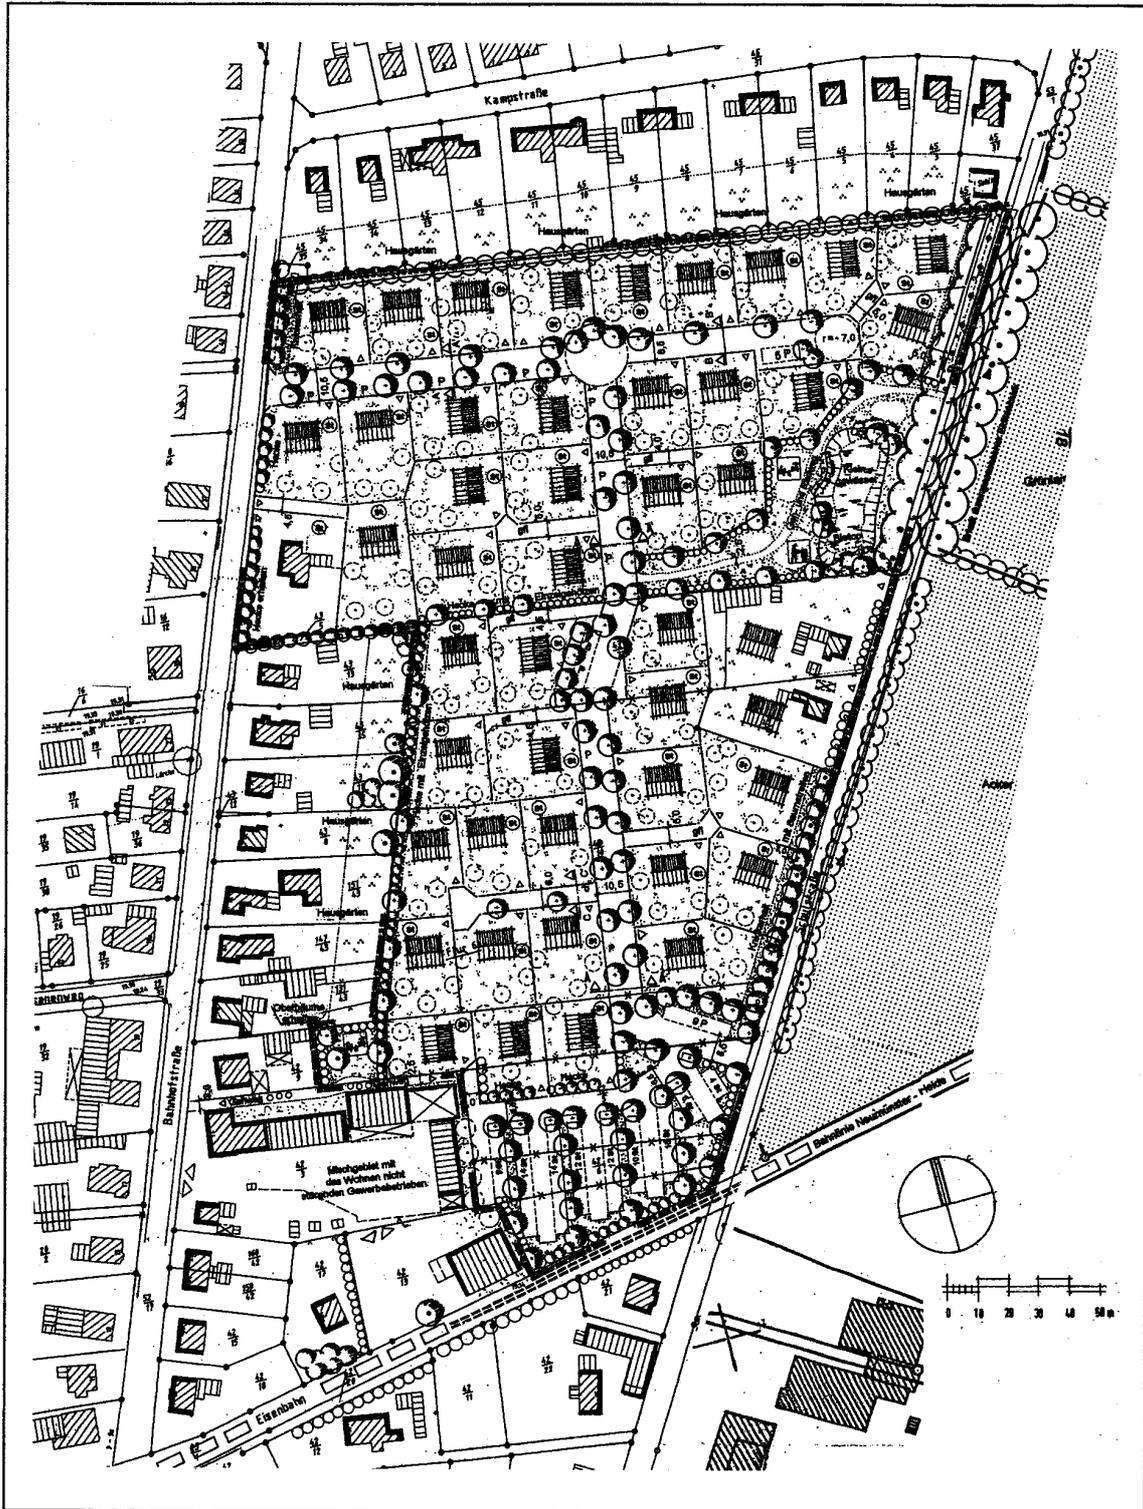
Planausschnitt aus dem „Städtebauliches Konzept mit integrierter Grünordnungsplanung“, Entwurf 5b vom 25.05.2000, unmaßstäblich
